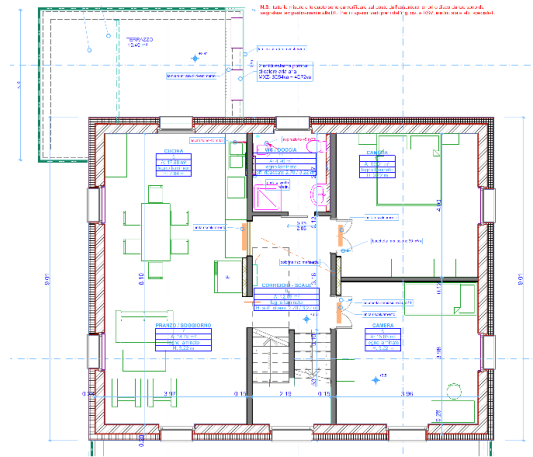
Grundriss 1. Stock mit beheizter Fläche
